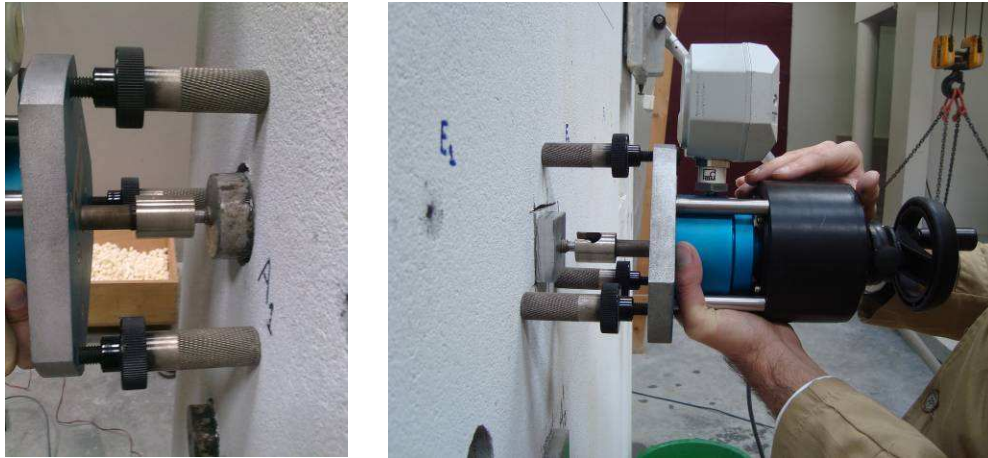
Acoplagem do motor-reductor e dinamómetro.
